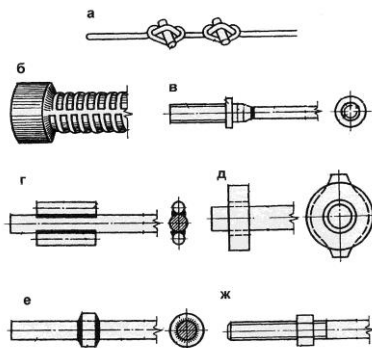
Методы анкерования напрягаемой арматуры:
